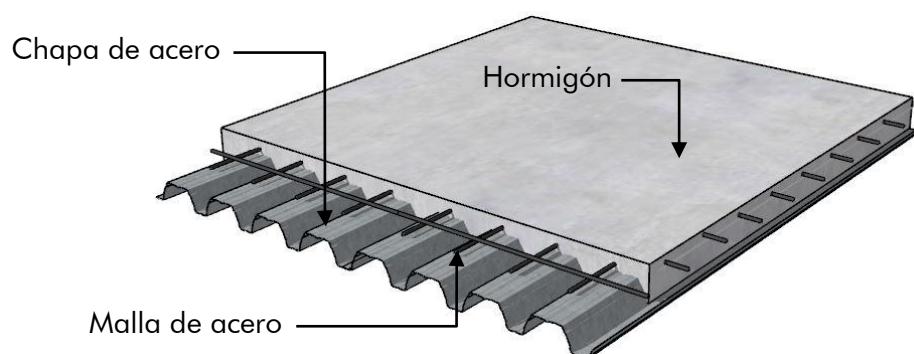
Losa mixta de hormigón con chapa de acero colaborante
